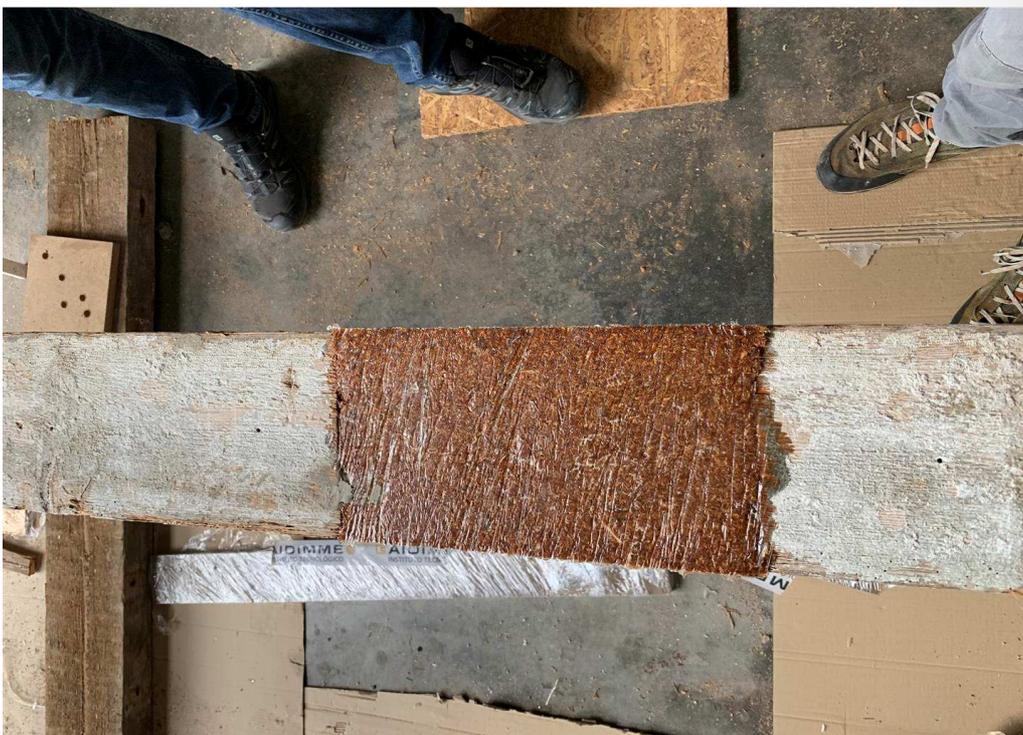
Detalle de una de las vigas anteriores después de ser consolidada.
